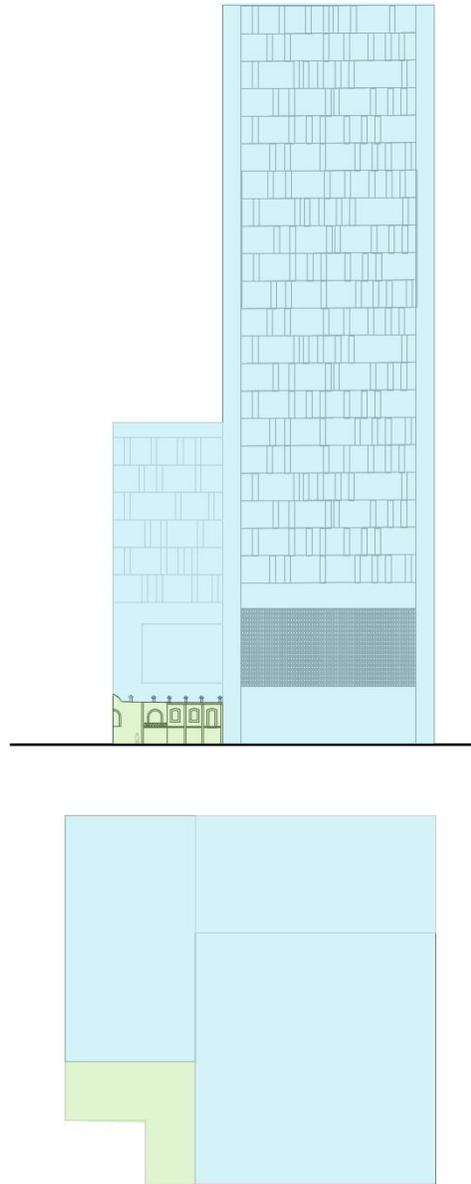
y 22: Corte y planta arquitectónica Torre Mapfre. Croquis elaborado por Paola Morales
